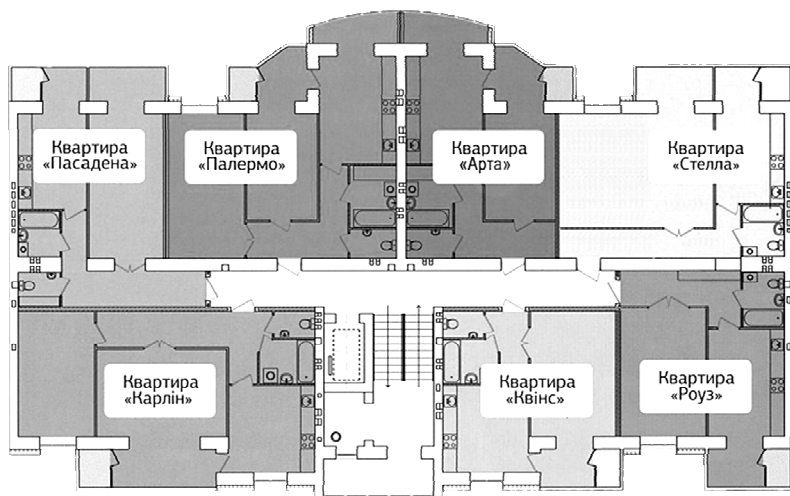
План типового поверху житлового комплексу «Набережний квартал»
